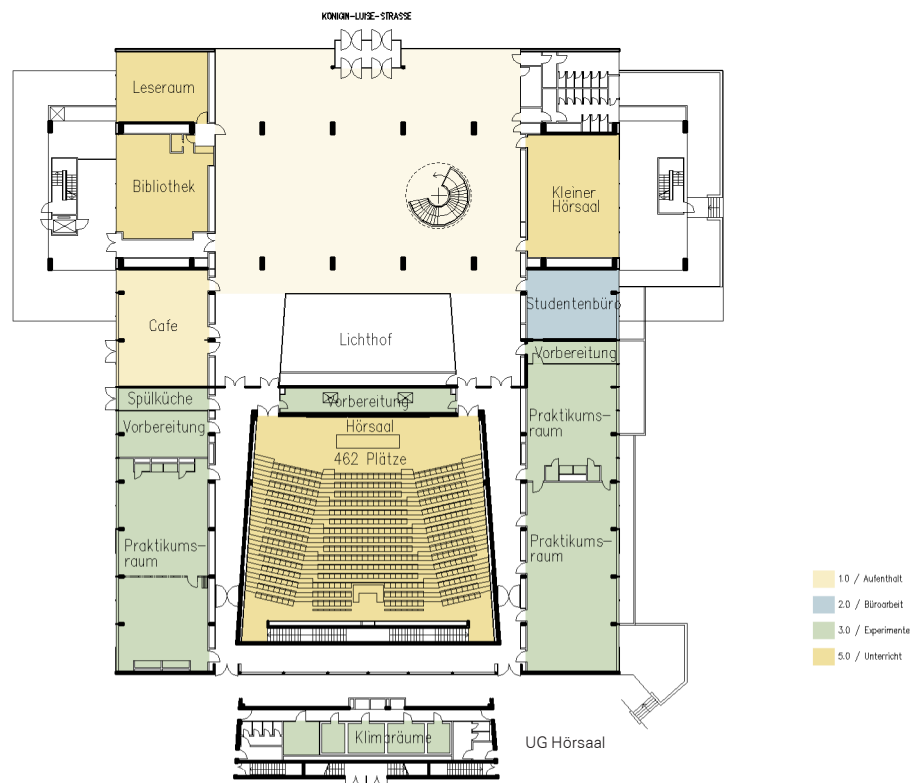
Grundriss Vorzugsvariante Erdgeschoss, Maßstab 1:750
